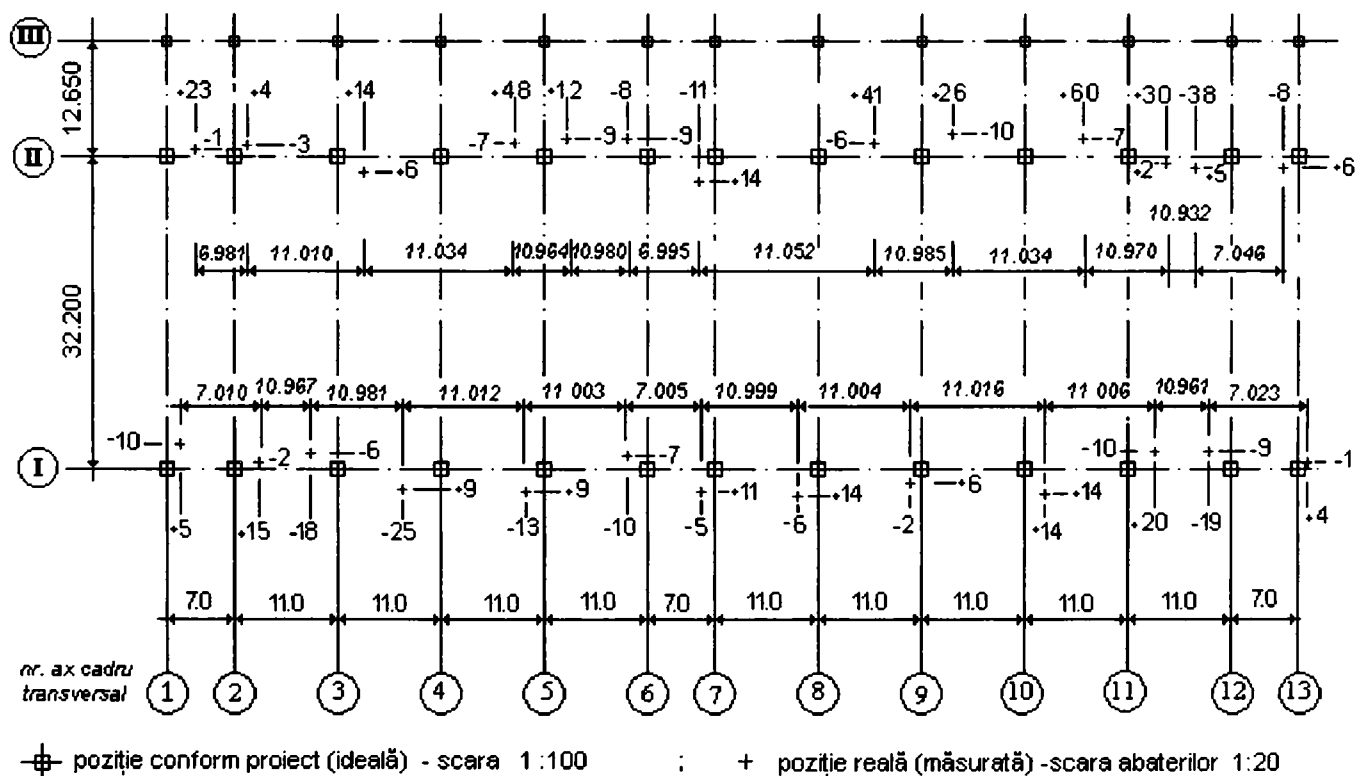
Schema pozițiilor stâlpilor cadrelor transversale, în secțiunea orizontală situată la nivelul 3 de măsurare
